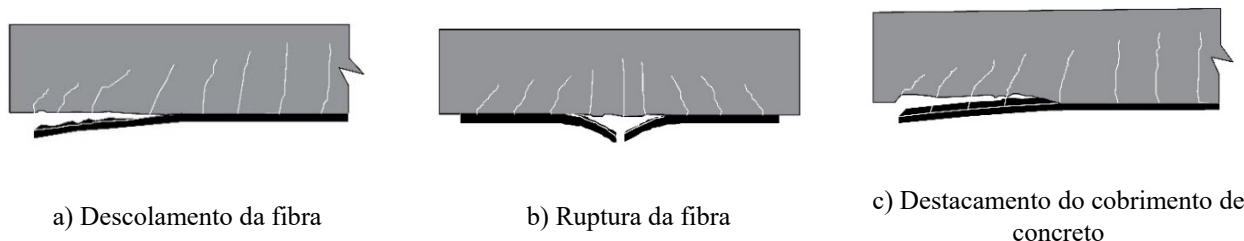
Tipos de rupturas frágeis em vigas reforçadas com PRFC
